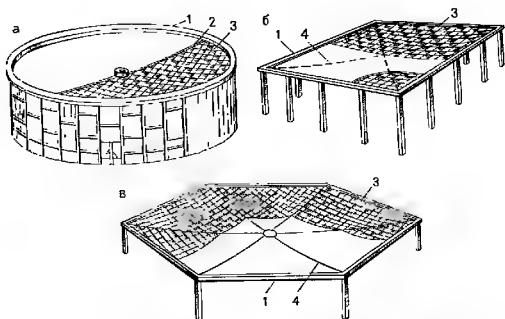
Покрытия с провисающими мембранами из переплетенных лент
